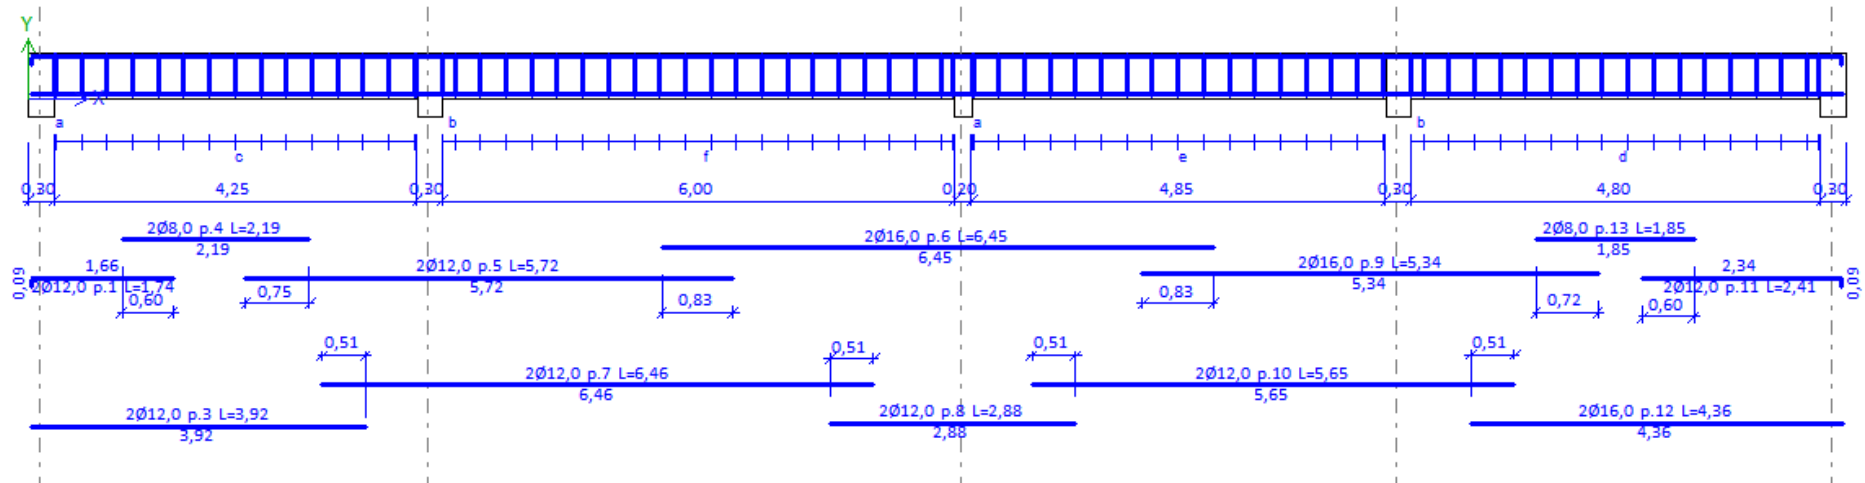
Armadura longitudinal V2-1, cálculo Robot.
